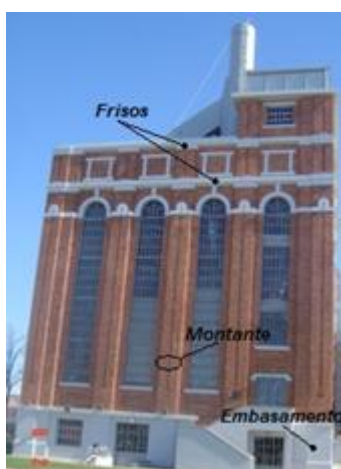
Representação de vários elementos da fachada. Fachada Poente do edifício de BP (fonte: António Gago).
